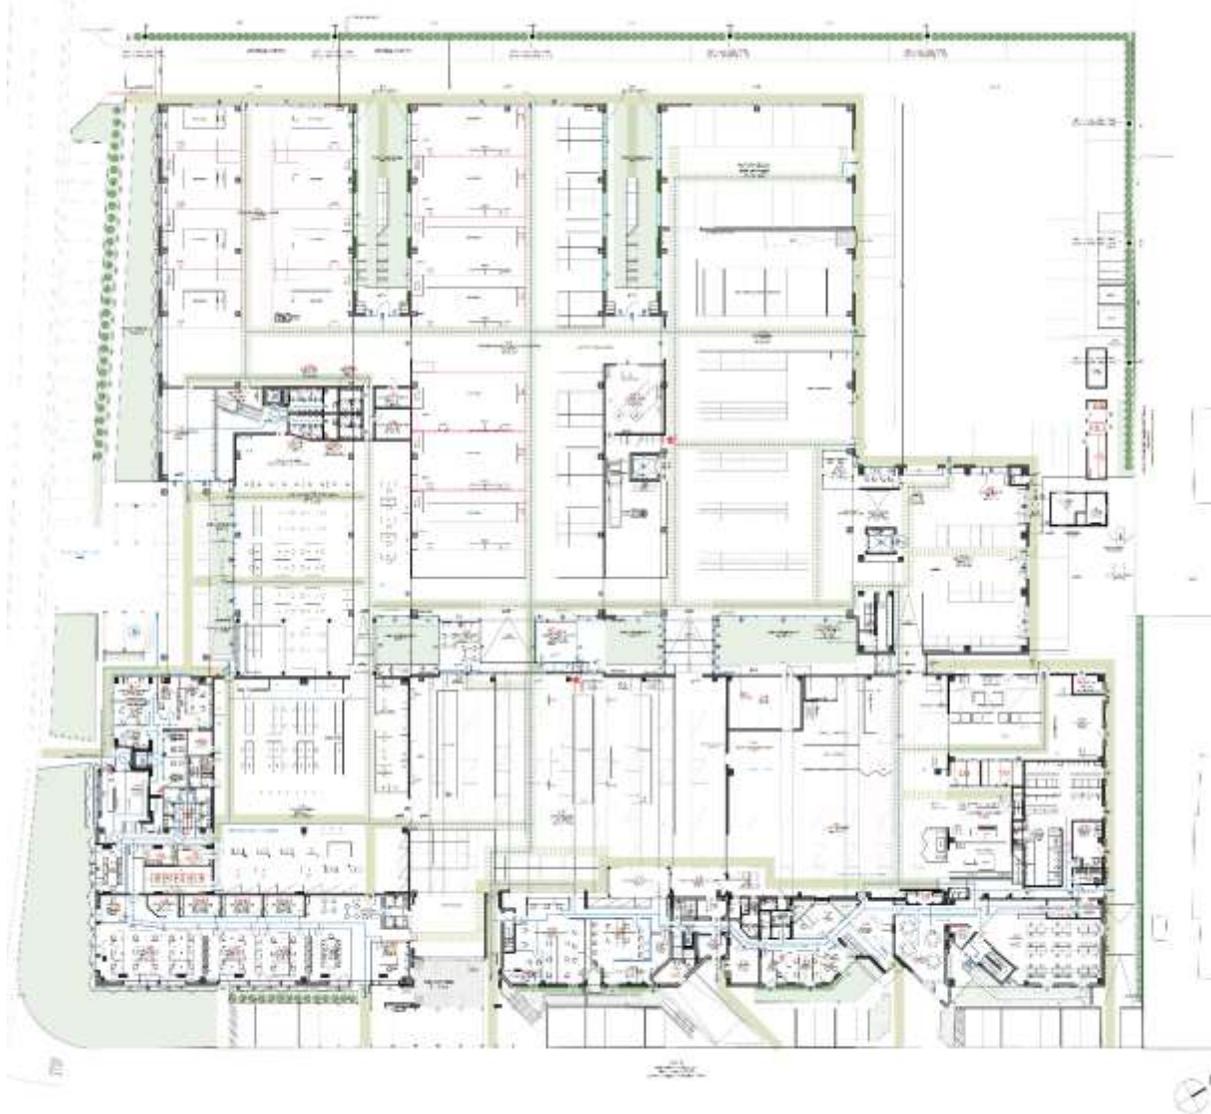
Estratto Tavola C.12: Progetto definitivo piano terra
